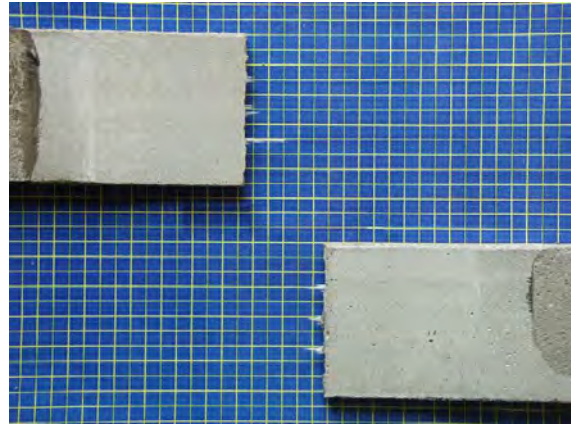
Betonprobekörper nach dem Zugversuch, IPF ARG mit Beschichtung (Bsp.: IPF ARG 1 P1), 28 d, Standardlagerung
